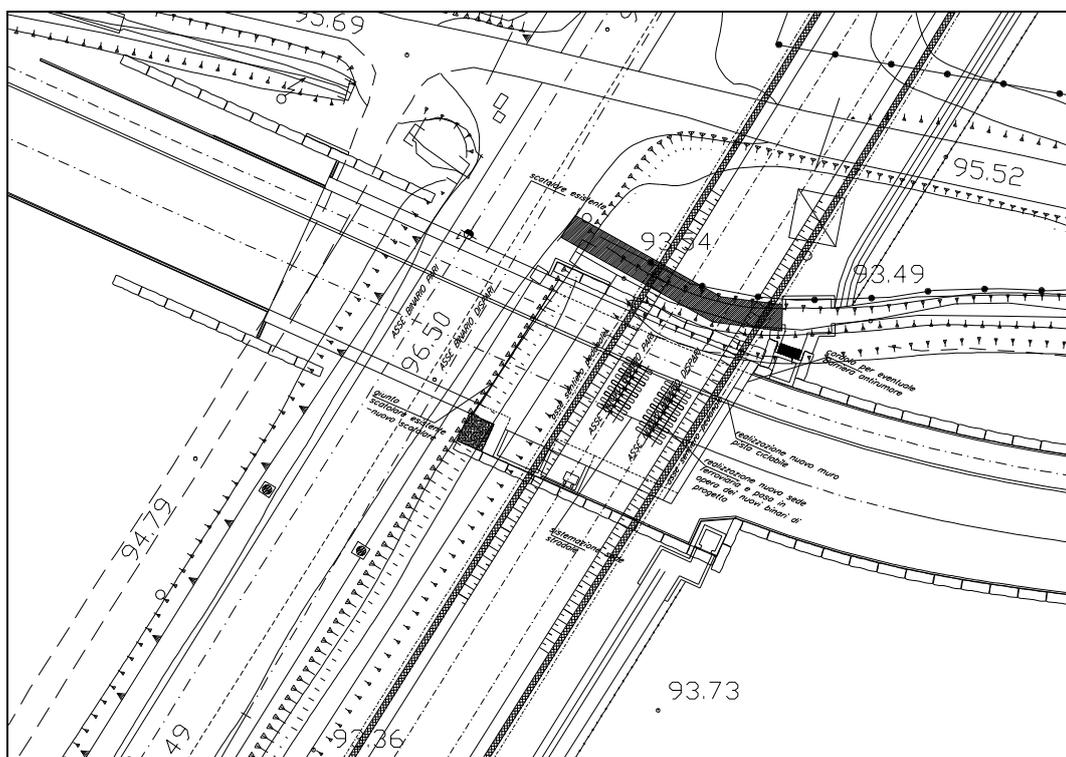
Pianta dell'intervento di prolungamento lato sud-est.
